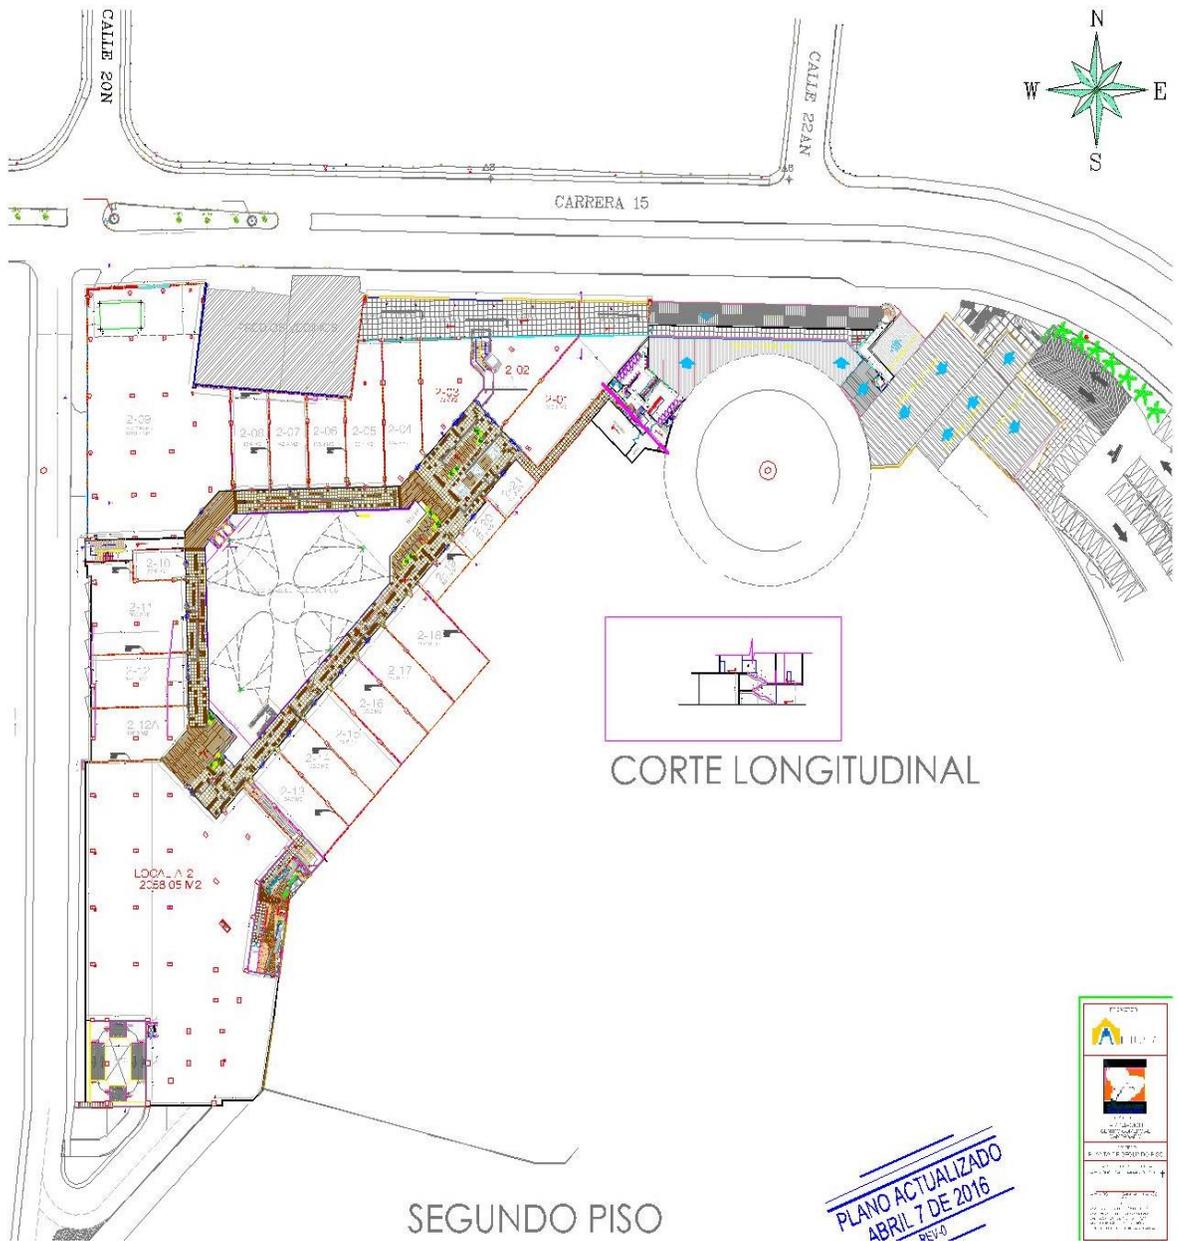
Planta arquitectónica, segundo piso. (Fuente: Diseño arquitectónico ARINSA)
